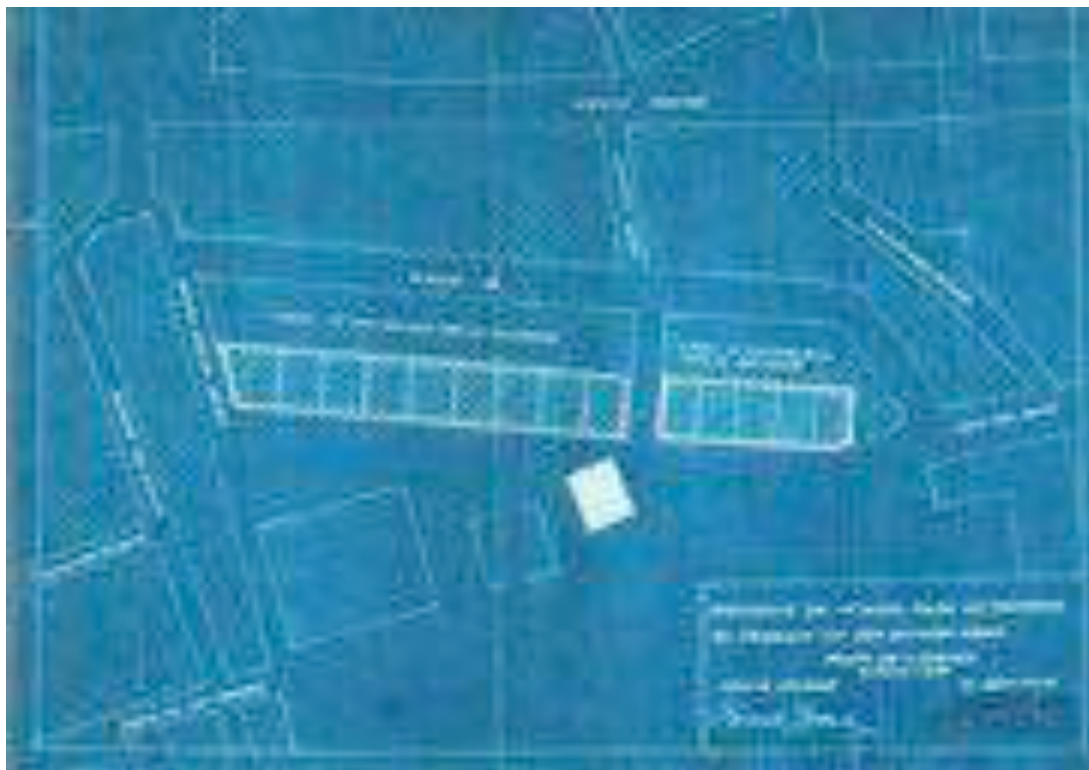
Proyecto de 14 casas para la Sociedad 'El Trabajo' en S. Antonio Abad. Plano de Situación. Víctor Beltrí. Septiembre 1934. AMC-CH-1908-1
